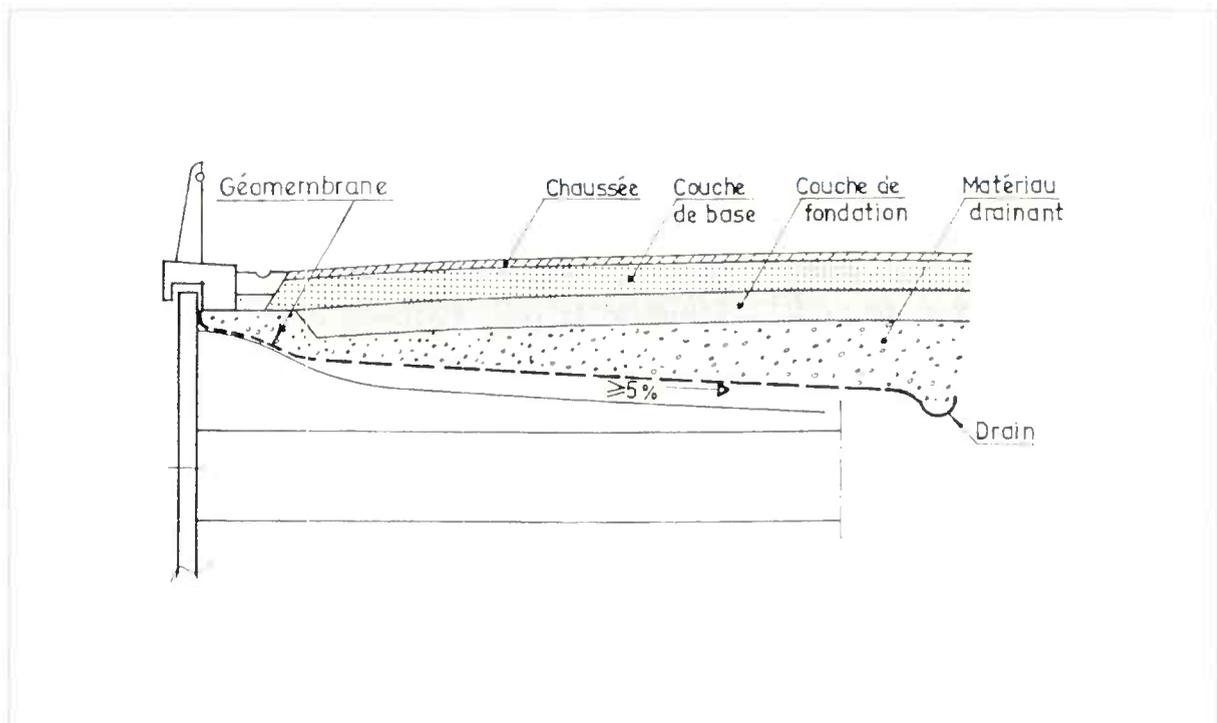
Protection contre les eaux de ruissellement sur un massif en remblai renforcé
